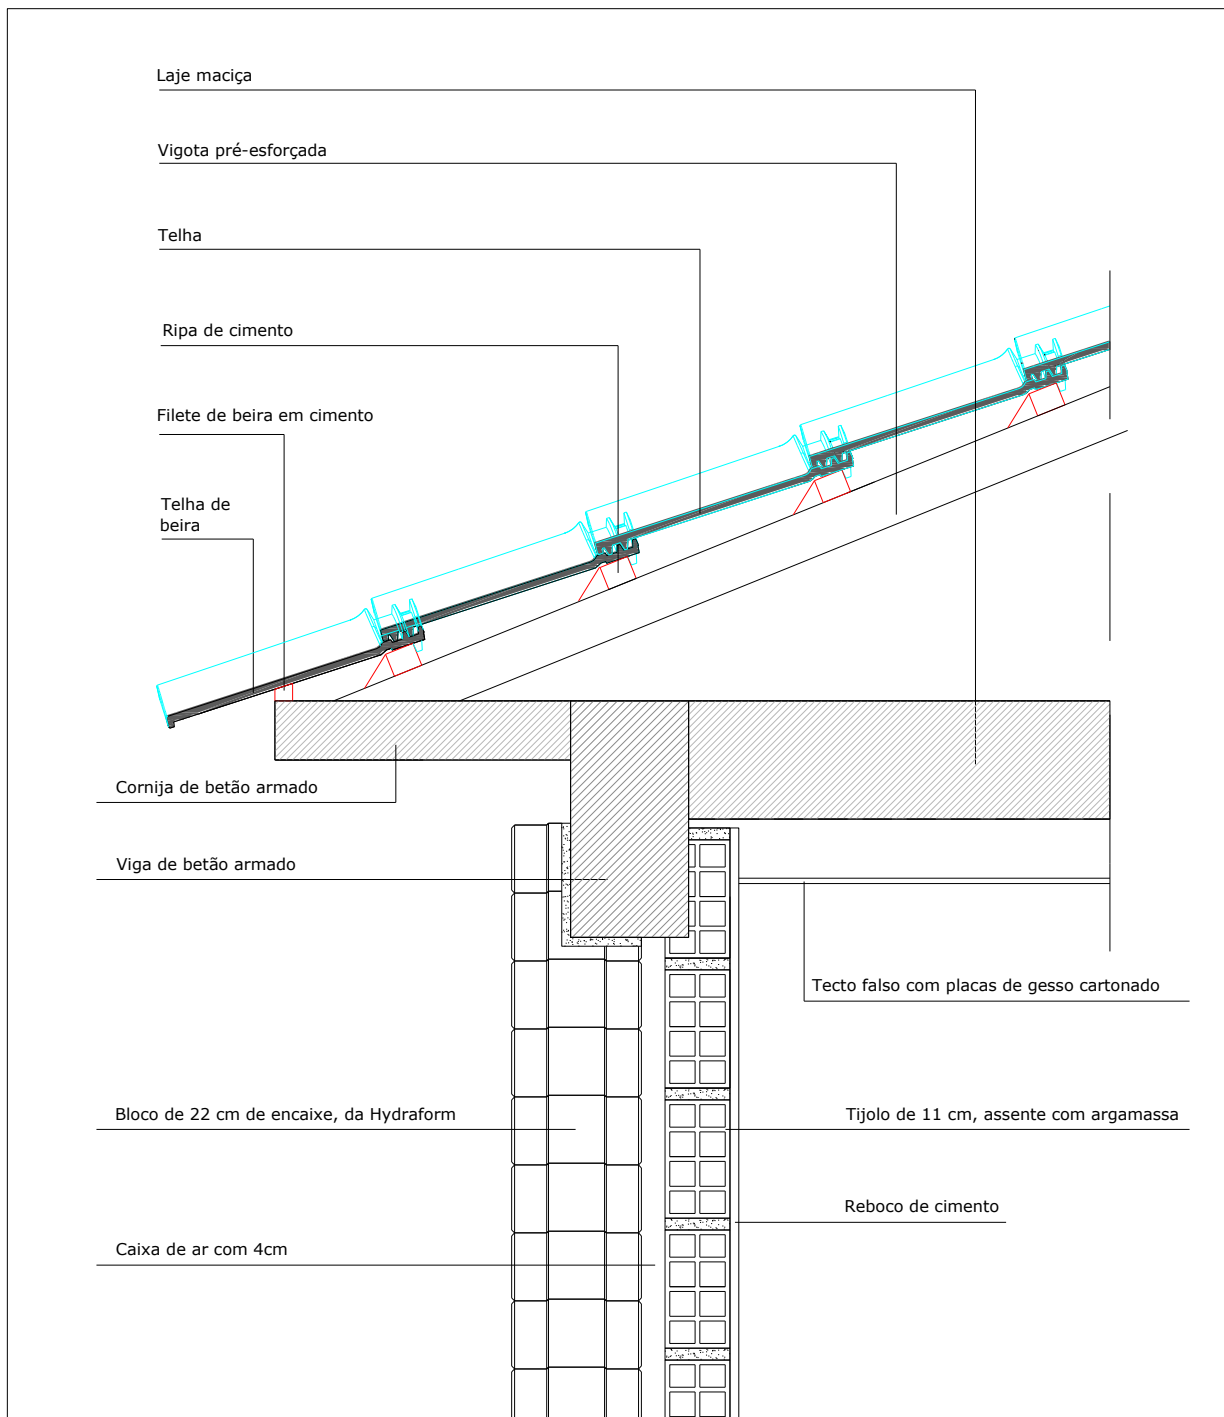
Corte representativo da parede dupla exterior (Com blocos de solo-cimento da Hydraform)
